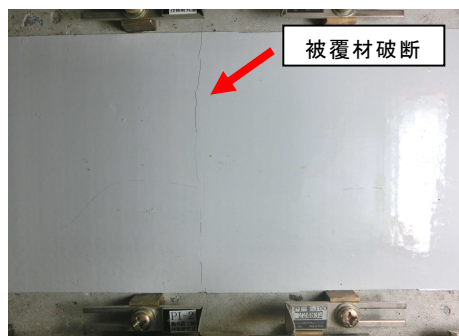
EP01 ひび割れ発生時 (下面)
